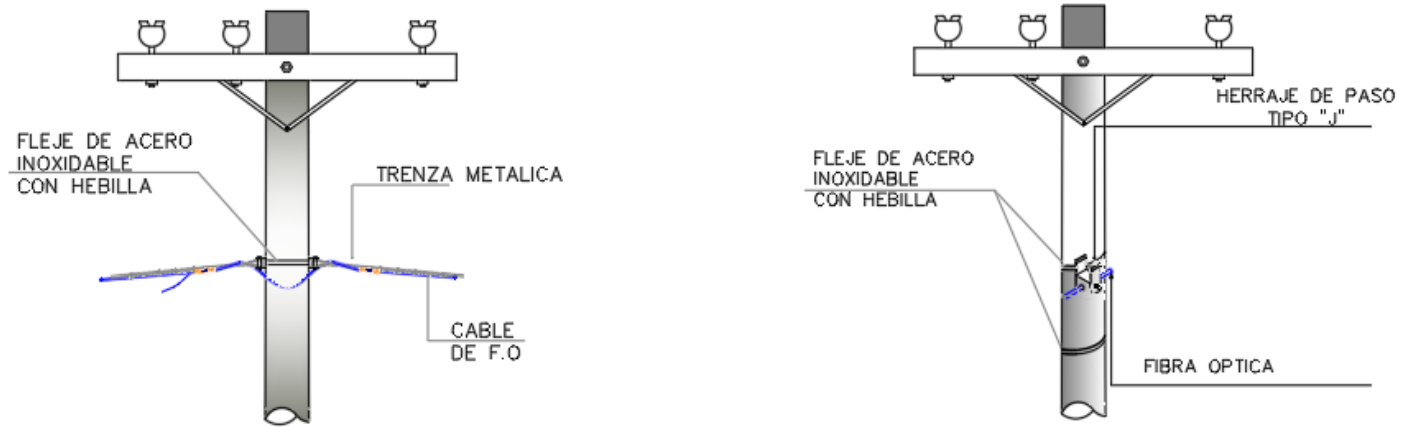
DETALLE DE INSTALACIÓN AÉREA EN POSTE DE MADERA O CONCRETO.
